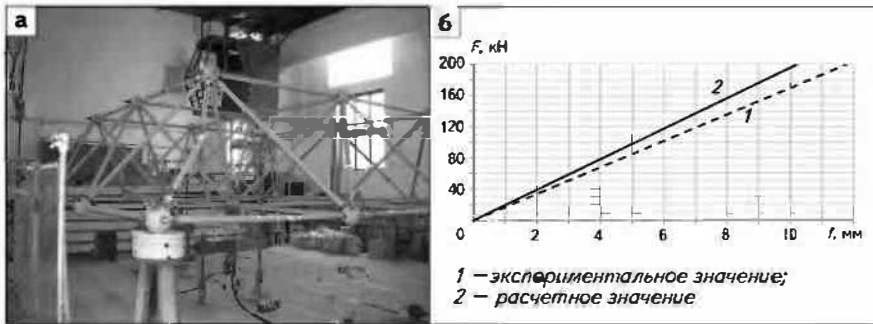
Испытание фрагмента с узловыми соединениями системы «БрГТУ» (а) и максимальные вертикальные перемещения узлов фрагмента при приложении нагрузки к нижнему поясу (б)
